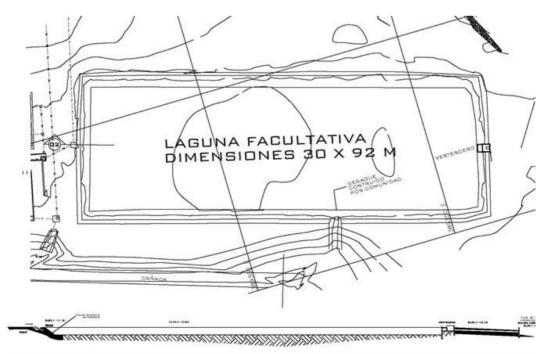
Planta y Sección Laguna Facultativa de Los Americanos Fuente: (Báez, 2014)
